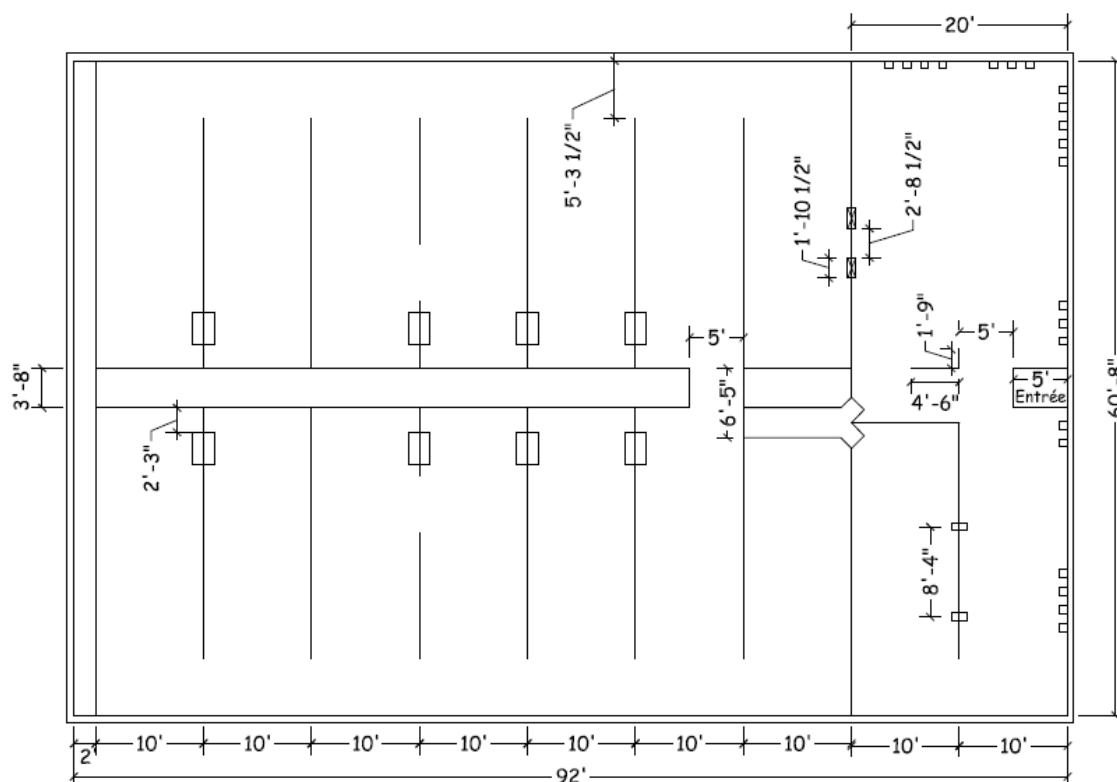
Plan de la salle A aménagée avec le bar à eau (BAE)
